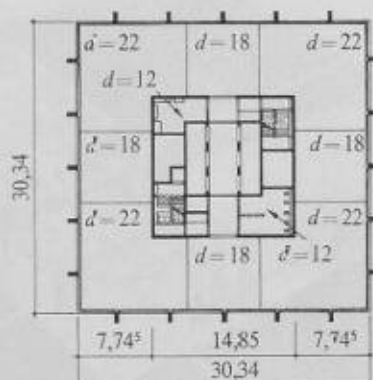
Normalgrundriss mit Angabe der Deckenstärken nach Variante 4, Bild 7
